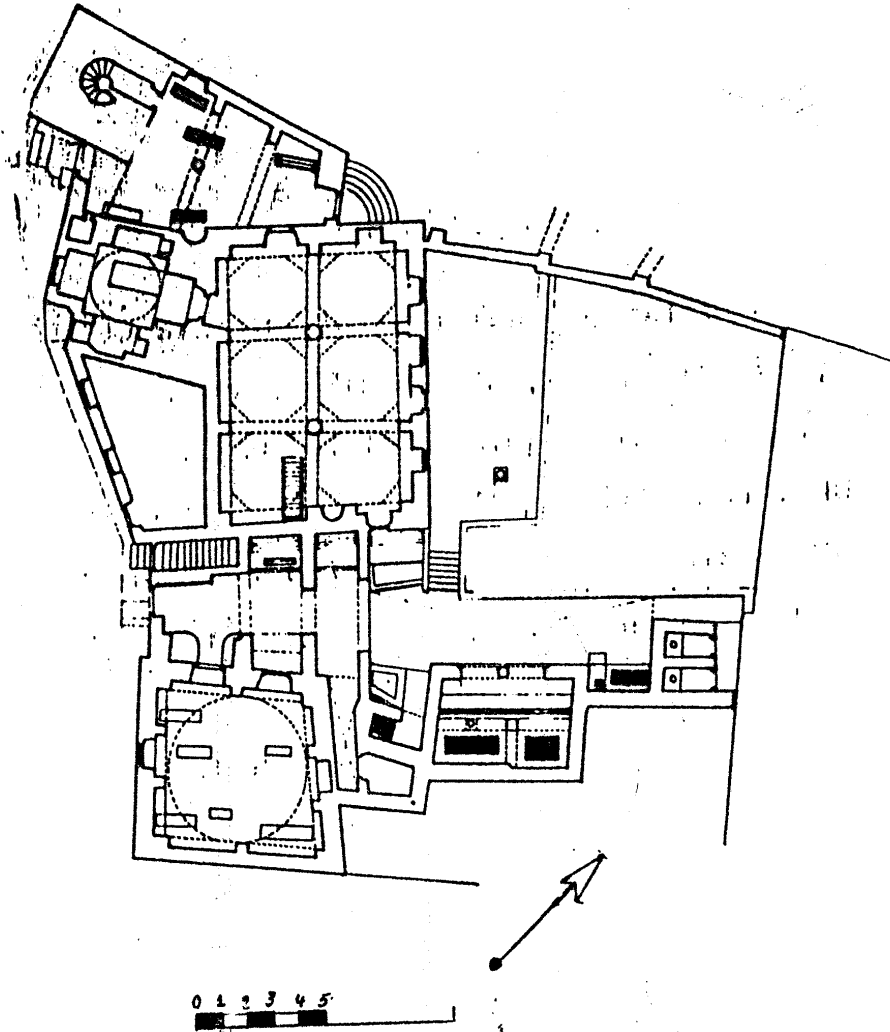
مسقط افق لجامع درغوت باشا (١٩٧٢م / ١٥٦٥م)
